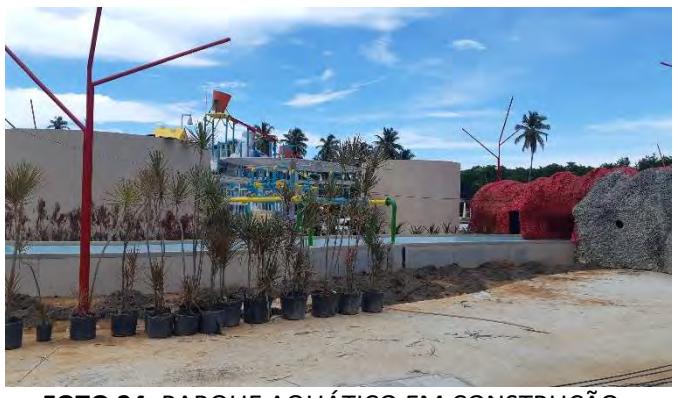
PARQUE AQUÁTICO EM CONSTRUÇÃO
